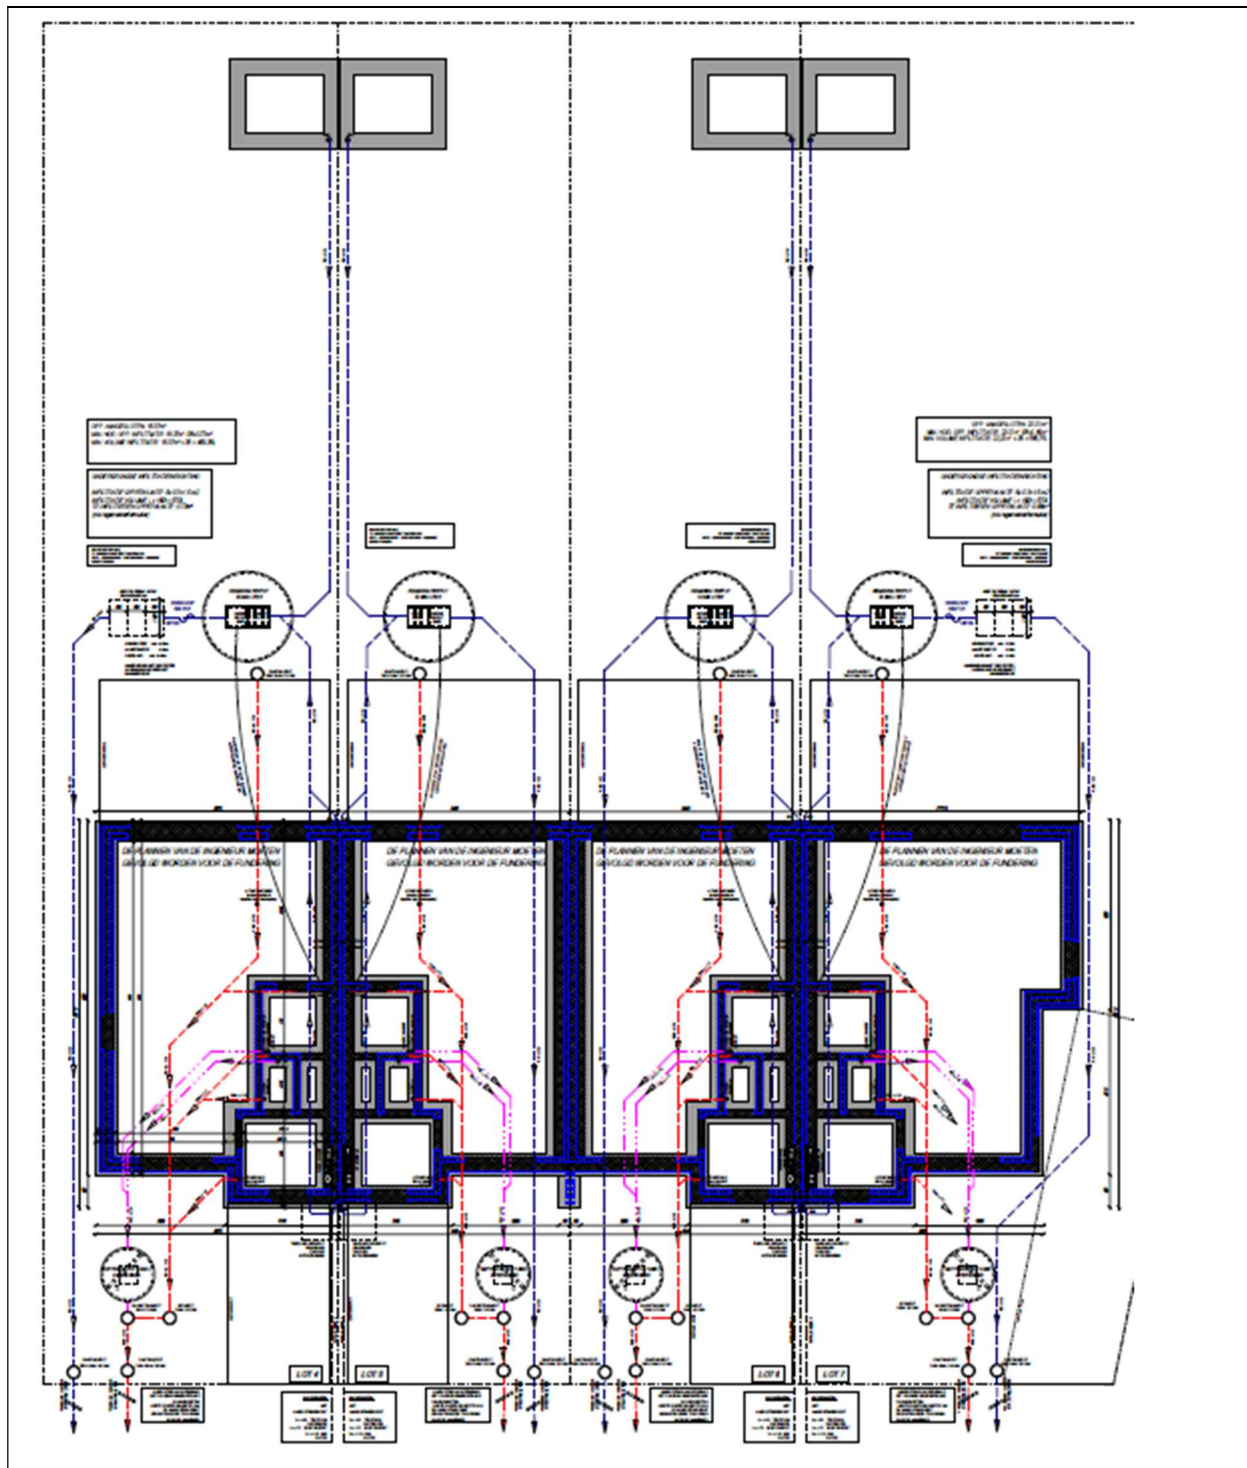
Funderingsplan en rioleringsplan loten 1-3.
